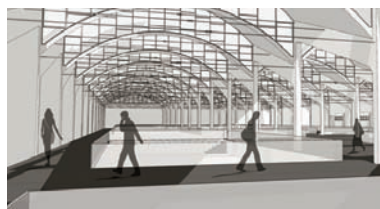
COTTONE D., *progetto di restauro, spaccato prospettico
